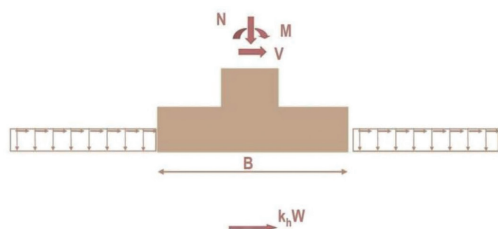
rappresentazione schematica dell'effetto dell'azione sismica sulla fondazione.
